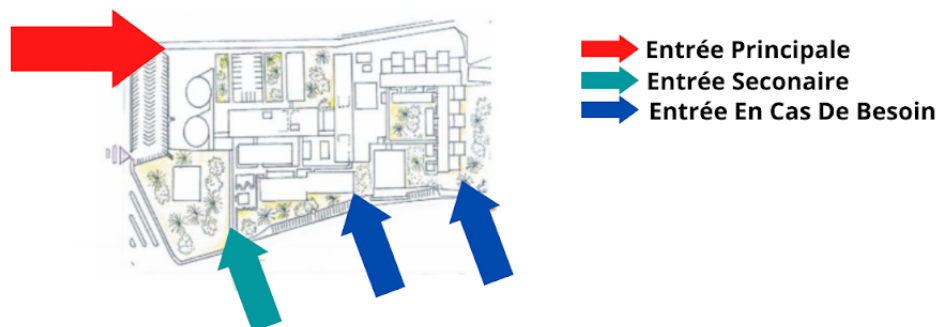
Plan d'accessibilités de l'EPAU - Traité par l'auteur
